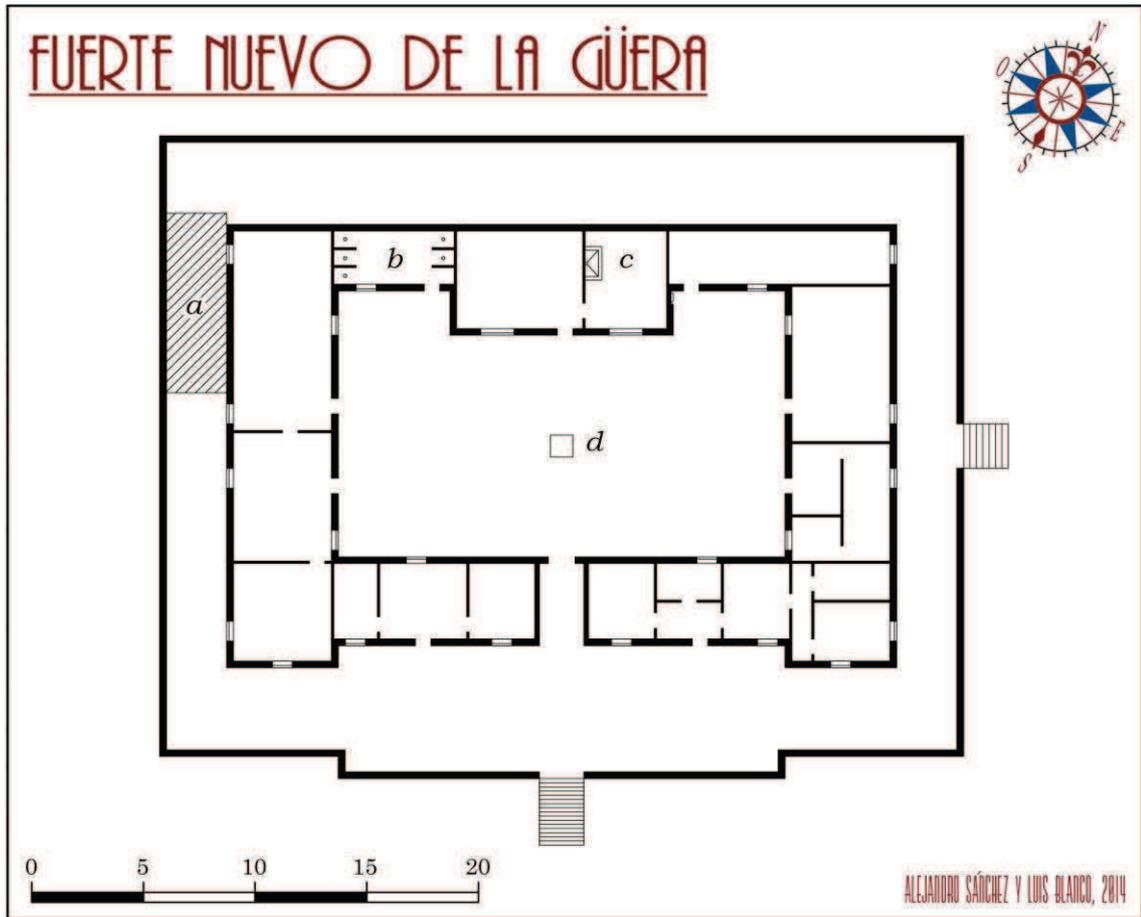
Planta del fuerte nuevo (a: añadido para letrinas, b: duchas, c: chimenea, d: aljibe)
